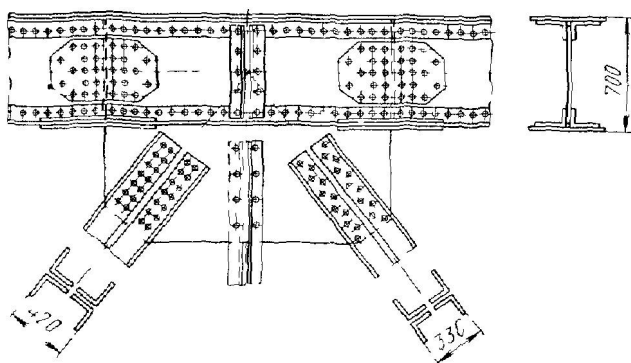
Вузол головної ферми з двутаровими перетинами поясів
